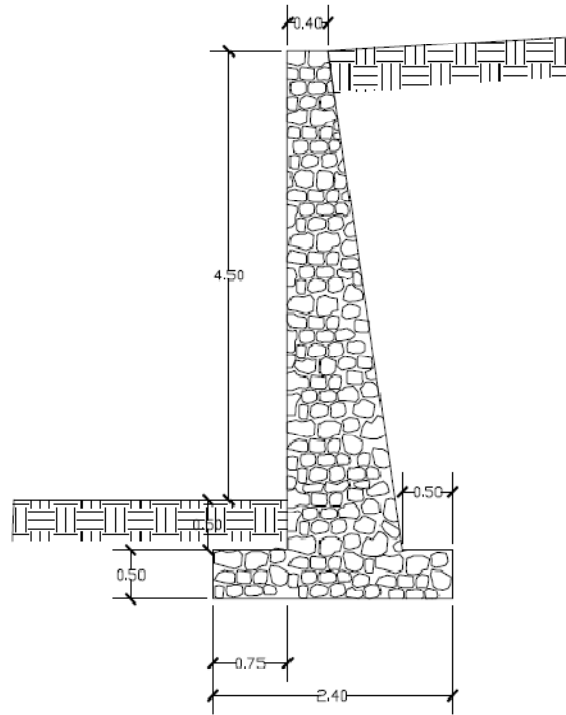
26 Detalle de muro de gravedad de mamposterías
